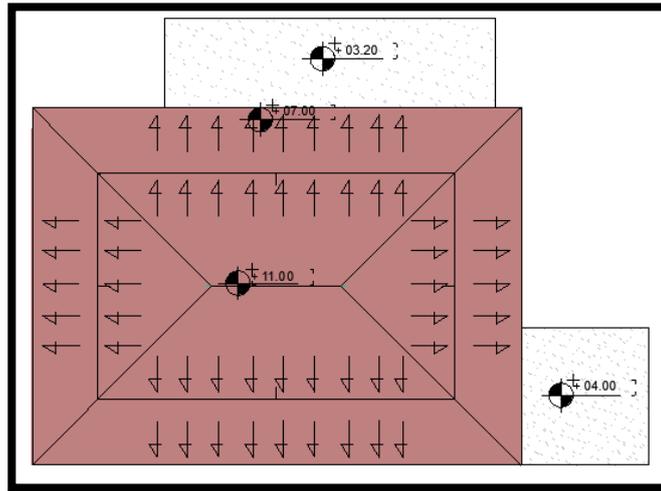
représente le plan de toiture du marché couvert. (Source : auteur).
